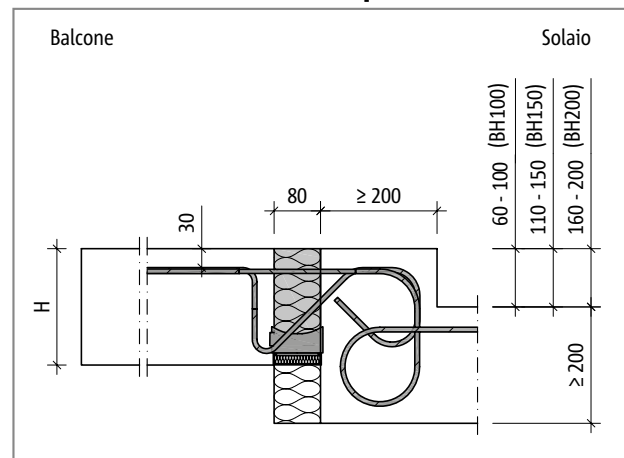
Schöck Isokorb® tipo K-BH, balcone con innalzamento e isolamento esterno
